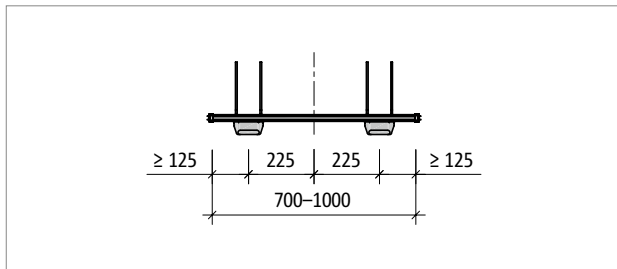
Schöck Tronsole® Typ T-V2...-L700 bis L1000: Produktgrundriss
